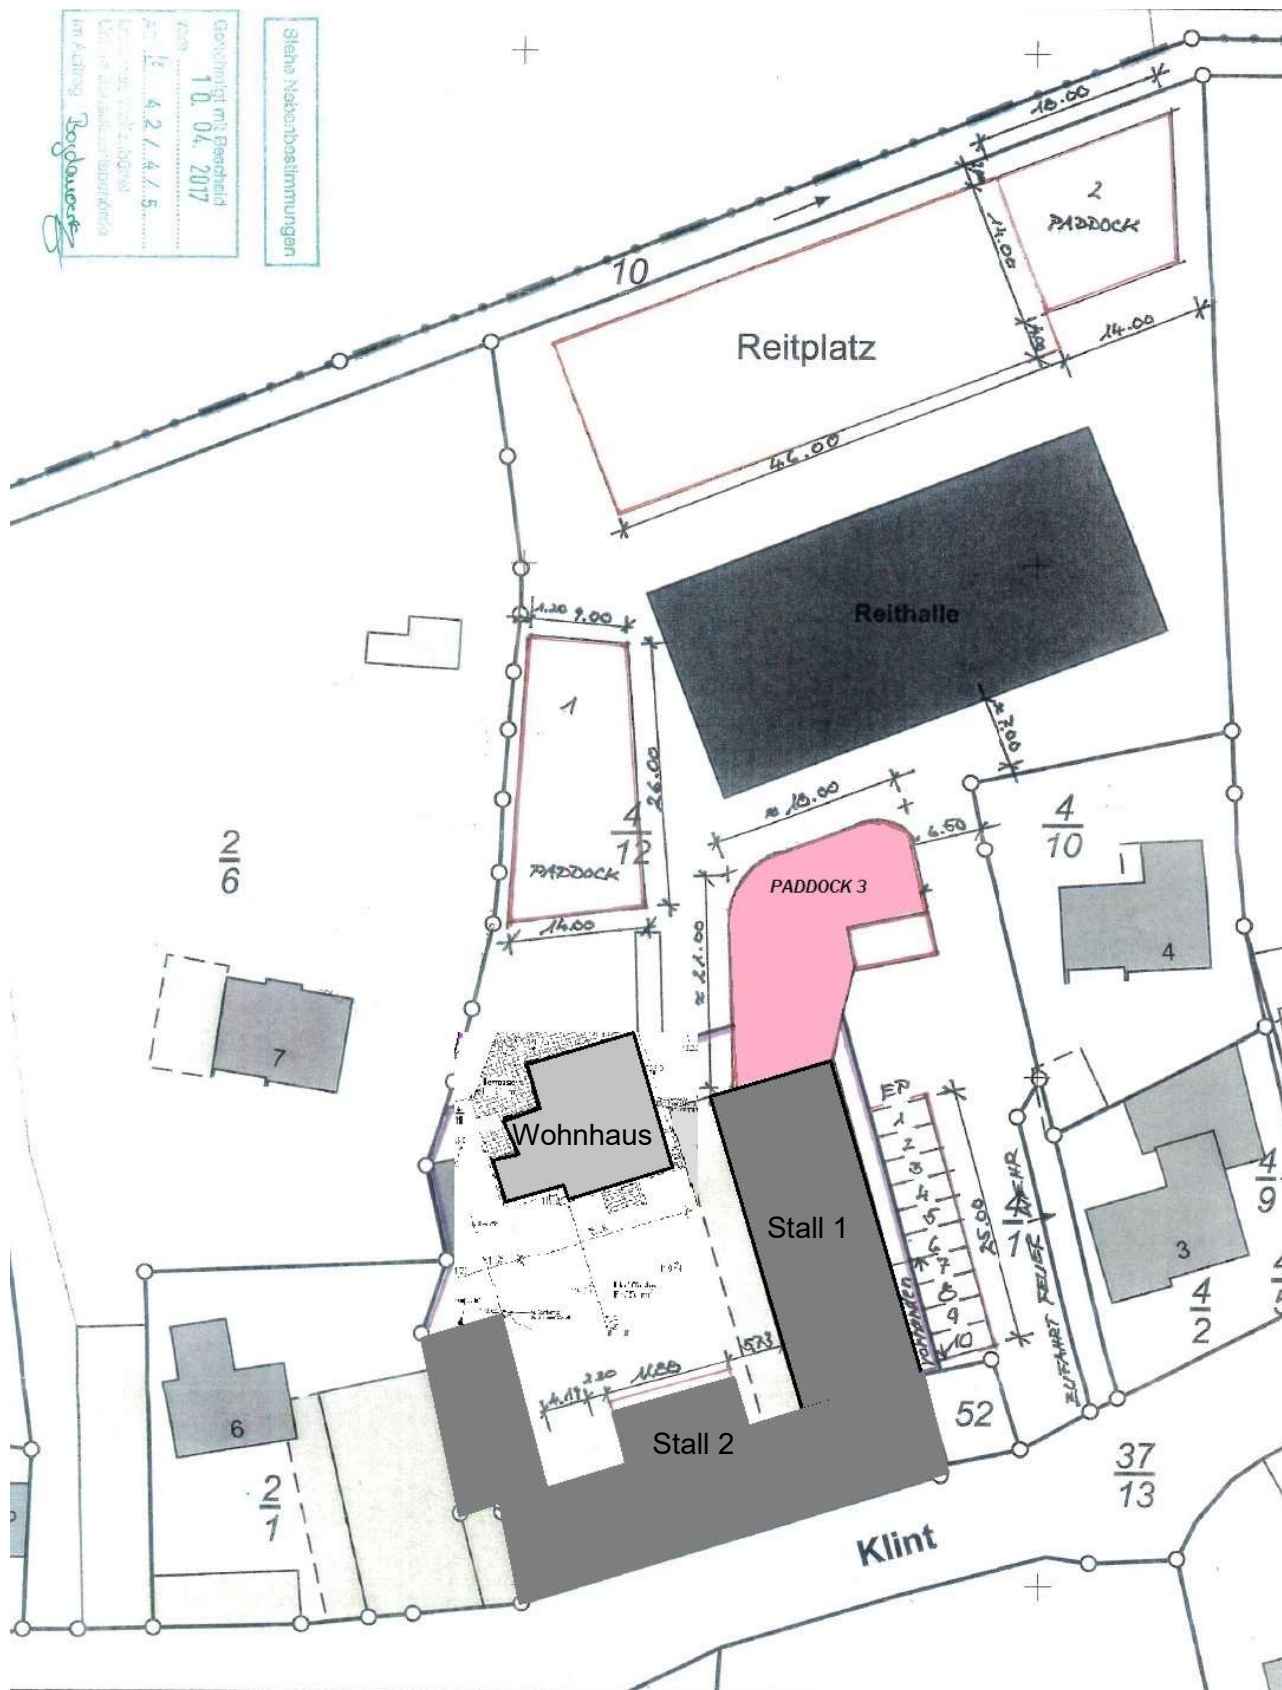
Lageplan des Pferdehofs „Klint 5“ /7/
